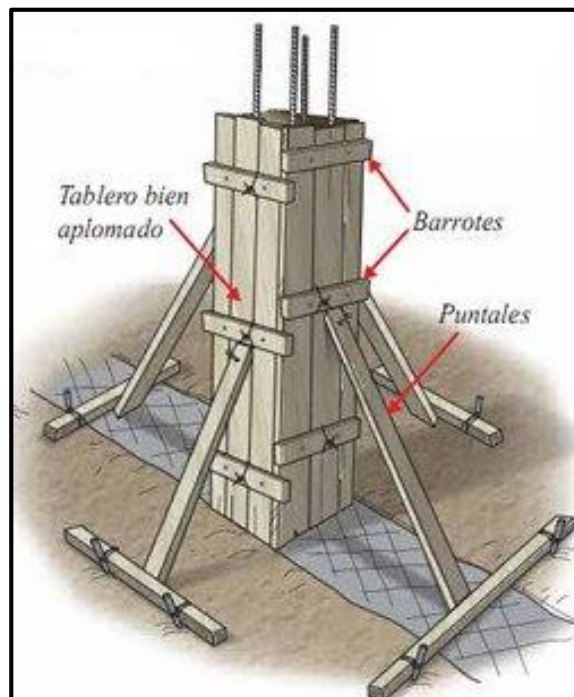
Encofrado de columna aislada. Fuente: Orihuela P. et al (2017).
